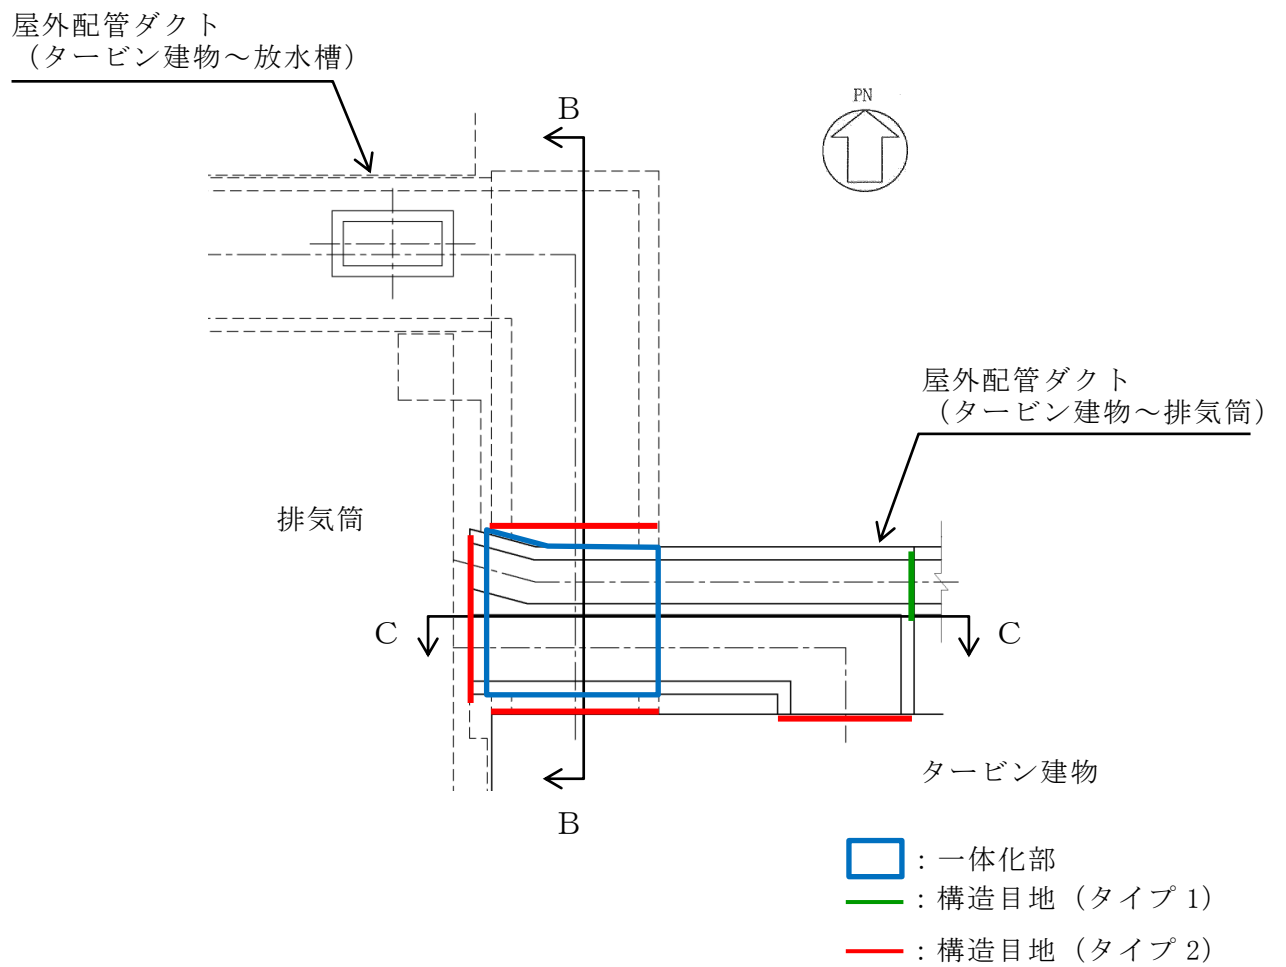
屋外配管ダクト (タービン建物～排気筒) 平面図
